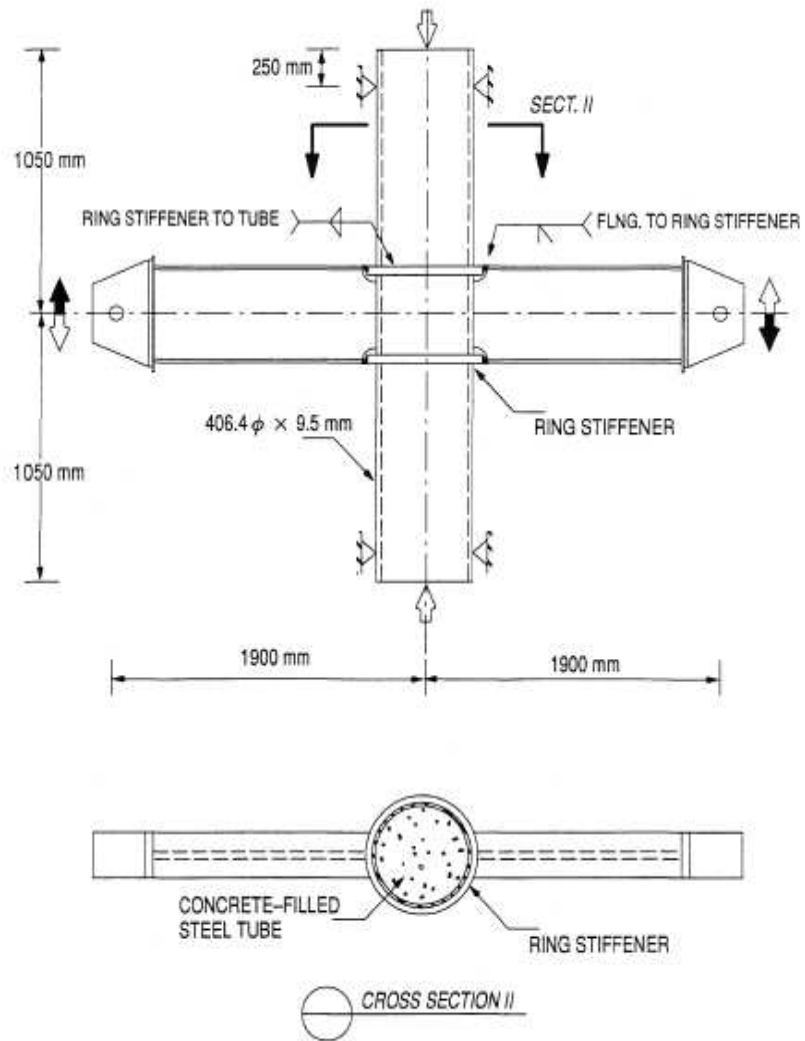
Elementi di connessione a tubi di sezione rettangolare studiati da Morino et al. (1992)
